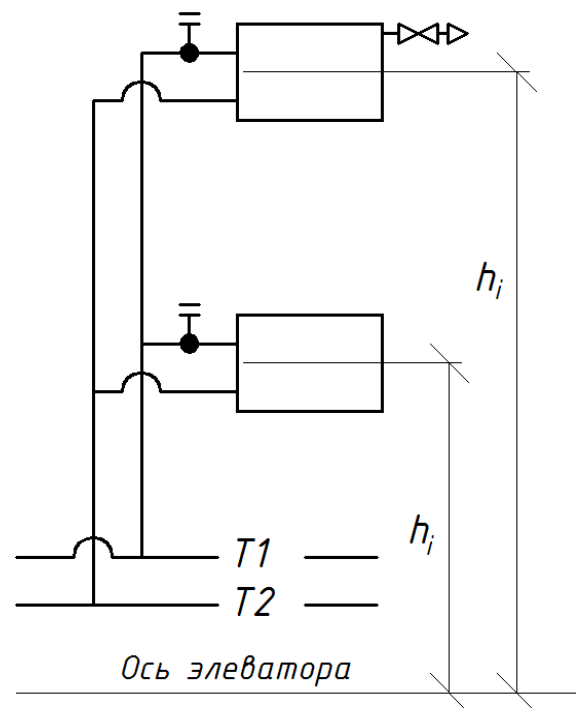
Расчетная схема вертикального двухтрубного стояка при нижней разводке
